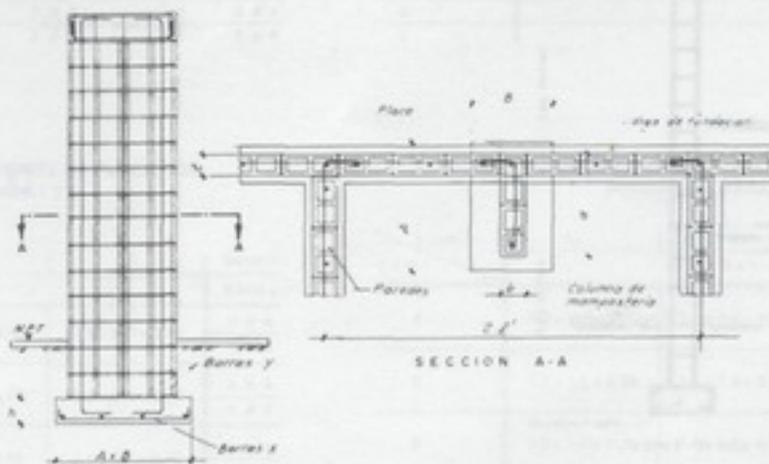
Detalle de columnas de mampostería con refuerzo integral.
